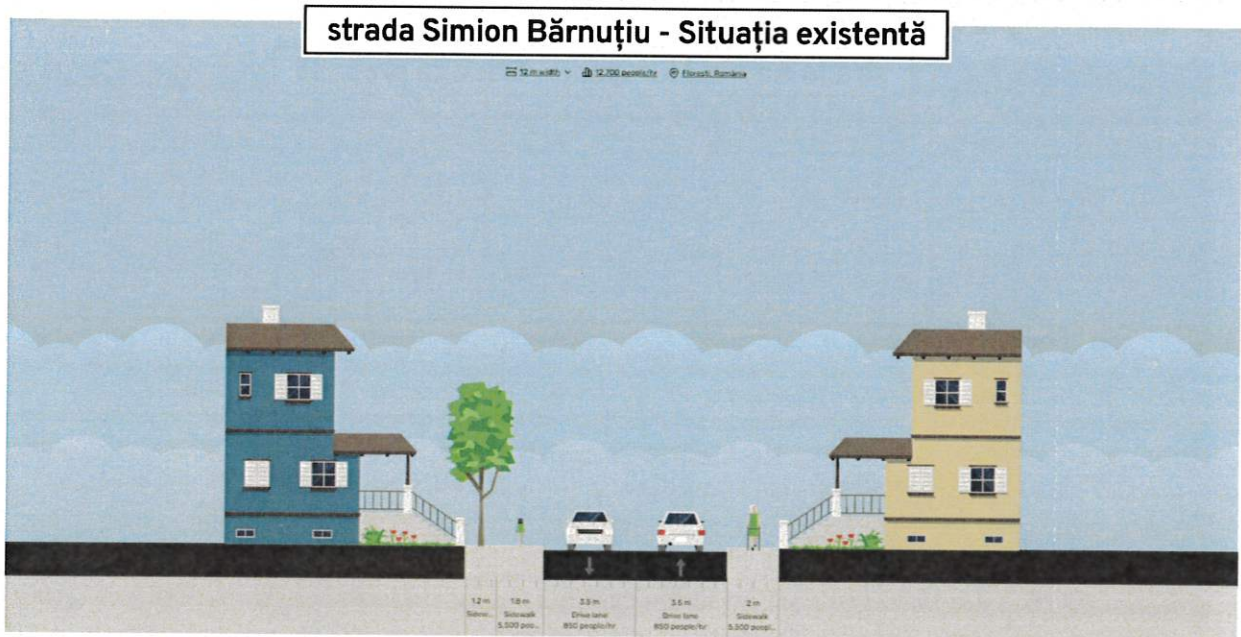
Profil transversal tip - Str. Simion Bărnuțiu situație existentă
